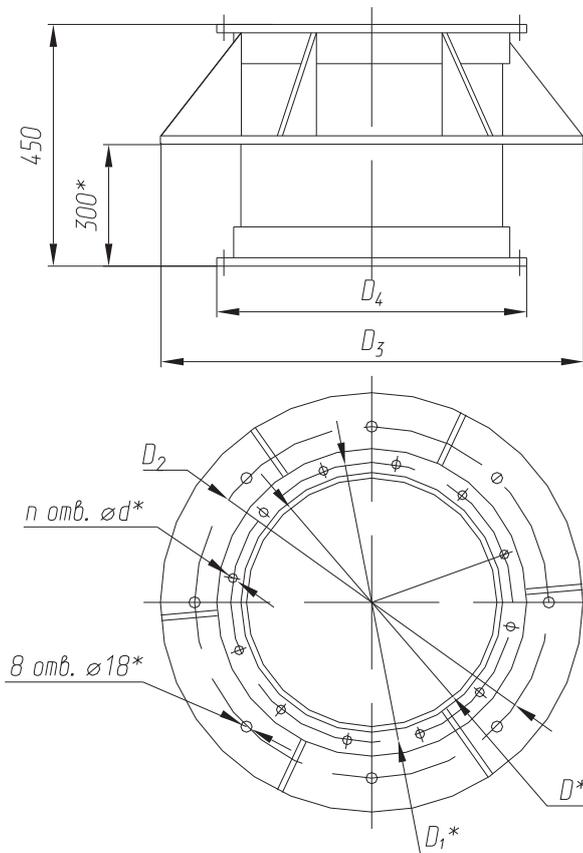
Схема монтажу установки для примусової вентиляції УВП
